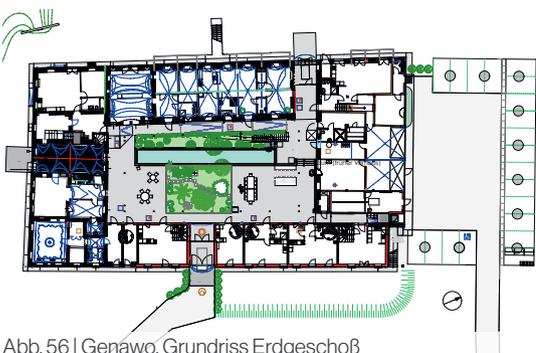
| Genawo. Grundriss Erdgeschoß
